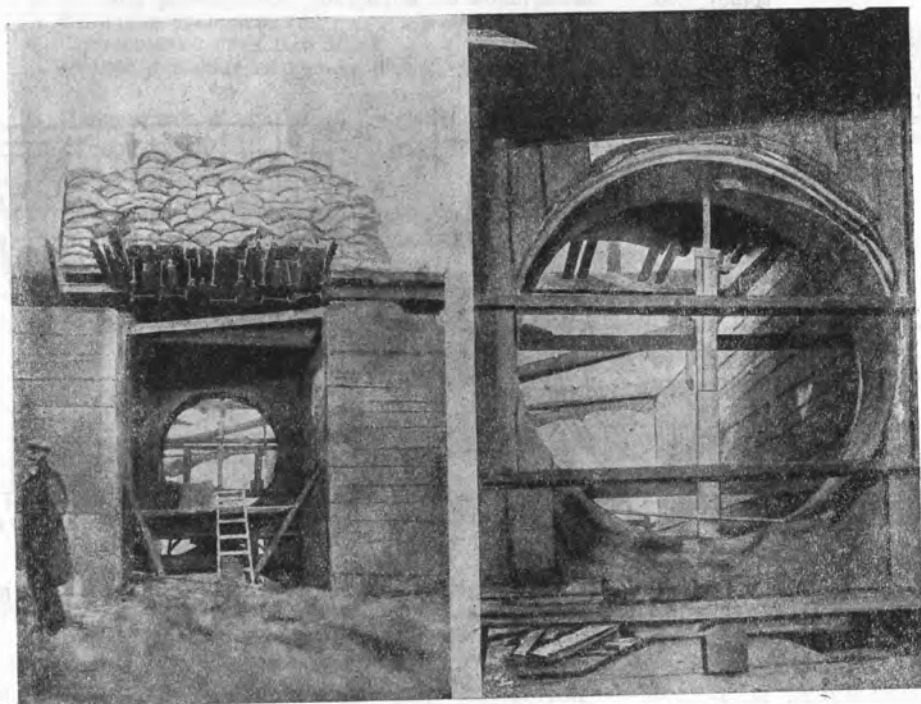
Испытание пробной нагрузкой tunnelной секции из бетонных блоков „Мкалпайн“. Деформации в блоках начали интенсивно нарастать после увеличения нагрузки за 114 тонн.
